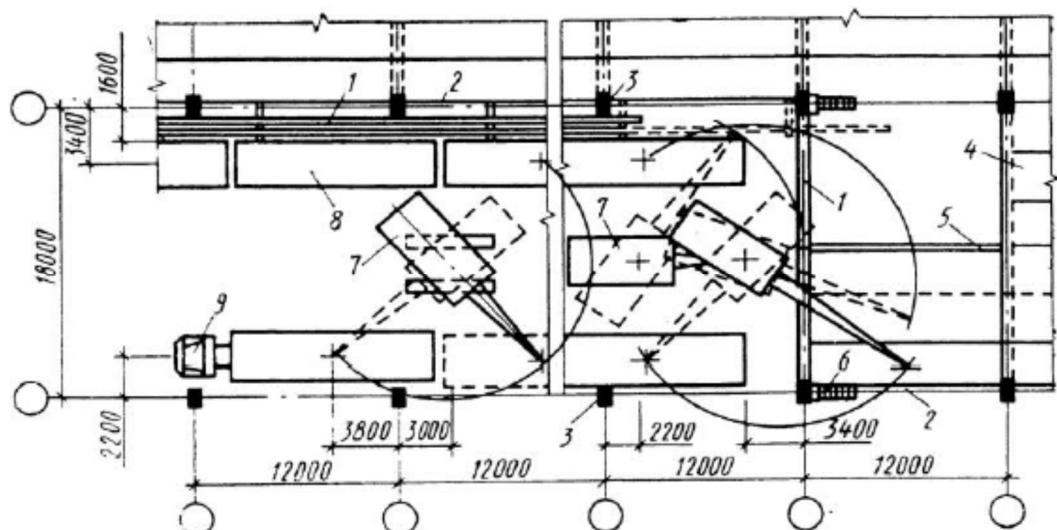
Схема выгрузки, раскладки элементов и монтажа покрытия в пролетах 18 м, с шагом колонн и ферм 12 м продольным методом: 1 - стропильная ферма; 2 - временное ограждение; 3 - колонна; 4 - смонтированное покрытие; 5 - инвентарная распорка для временного крепления ферм; 6 - лестница-площадка приставная; 7 - кран; 8 - штабель плит; 9 - транспортное средство.
